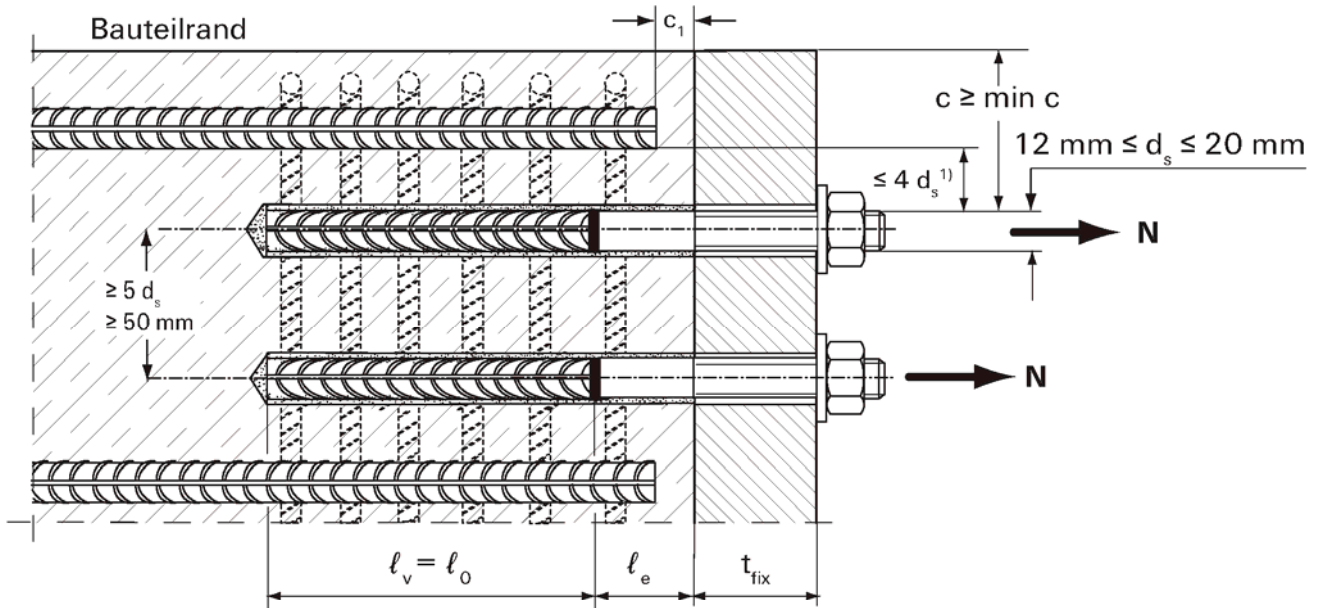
Einbau Bewehrungsanker BRA (Beispiel: Ausführung Glattschaft)
